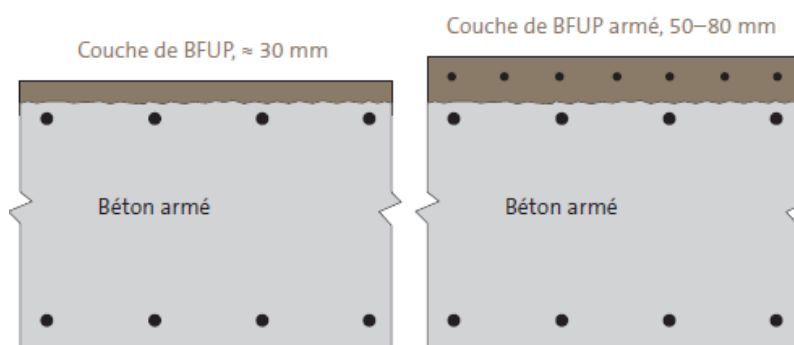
Protection ou renforcement d’un béton armé par une couche de BFUP.
